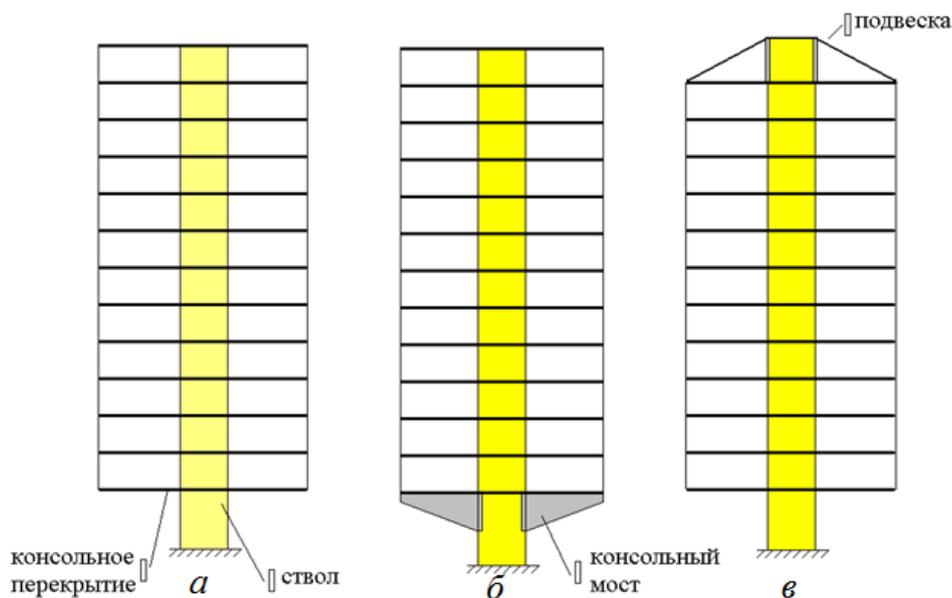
Конструктивные схемы монолитных многоэтажных зданий ствольной конструктивной системы: а – консольная, б – этажерочная, в - подвесная
